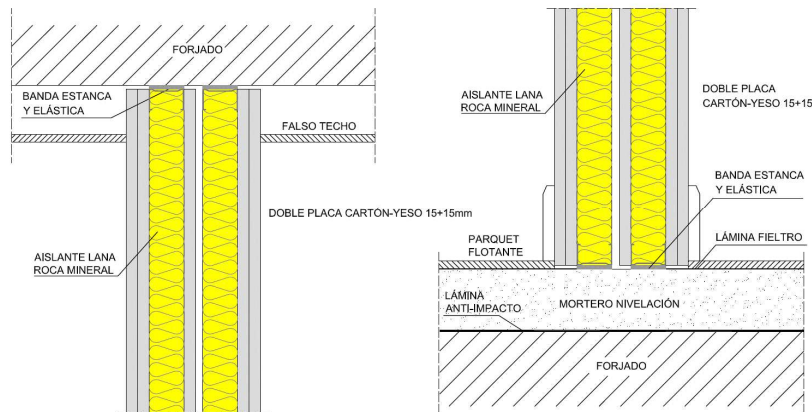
y 37. Detalle encuentro con pavimento y con falso techo.
